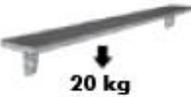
Cargas pesadas aplicadas/ reforço com suporte metálico.
